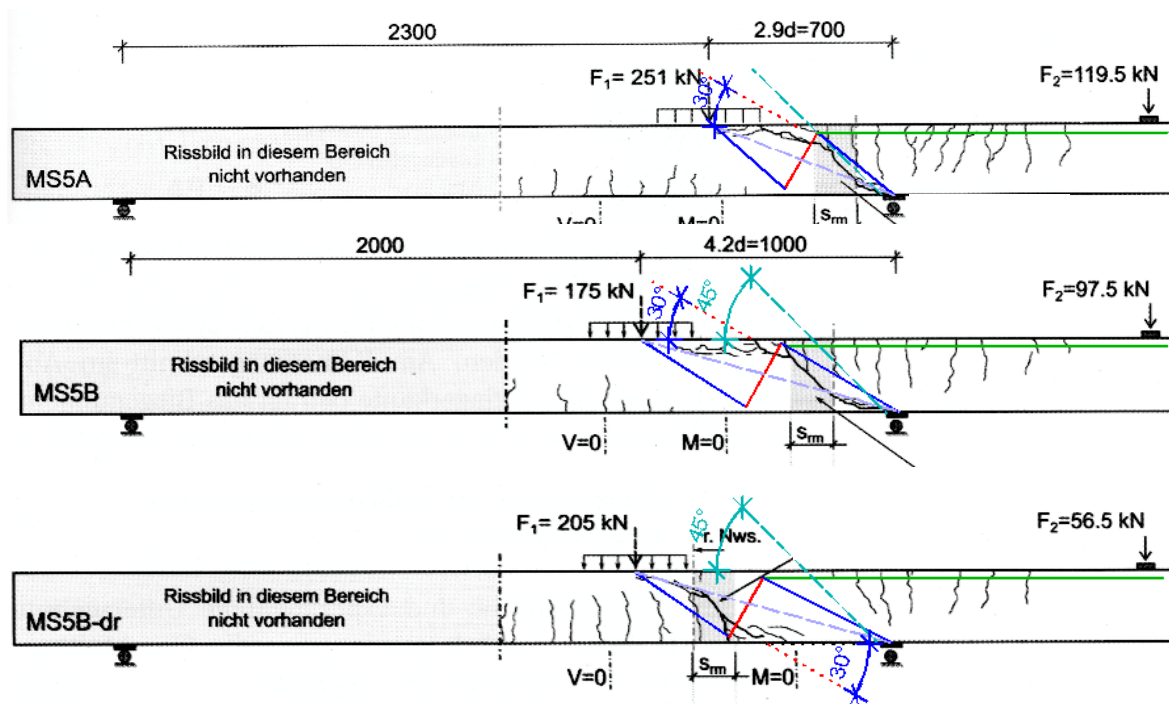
Zweifeldrige Stahlbetonbalken mit Einzellasten nach [4] bzw. [7]
